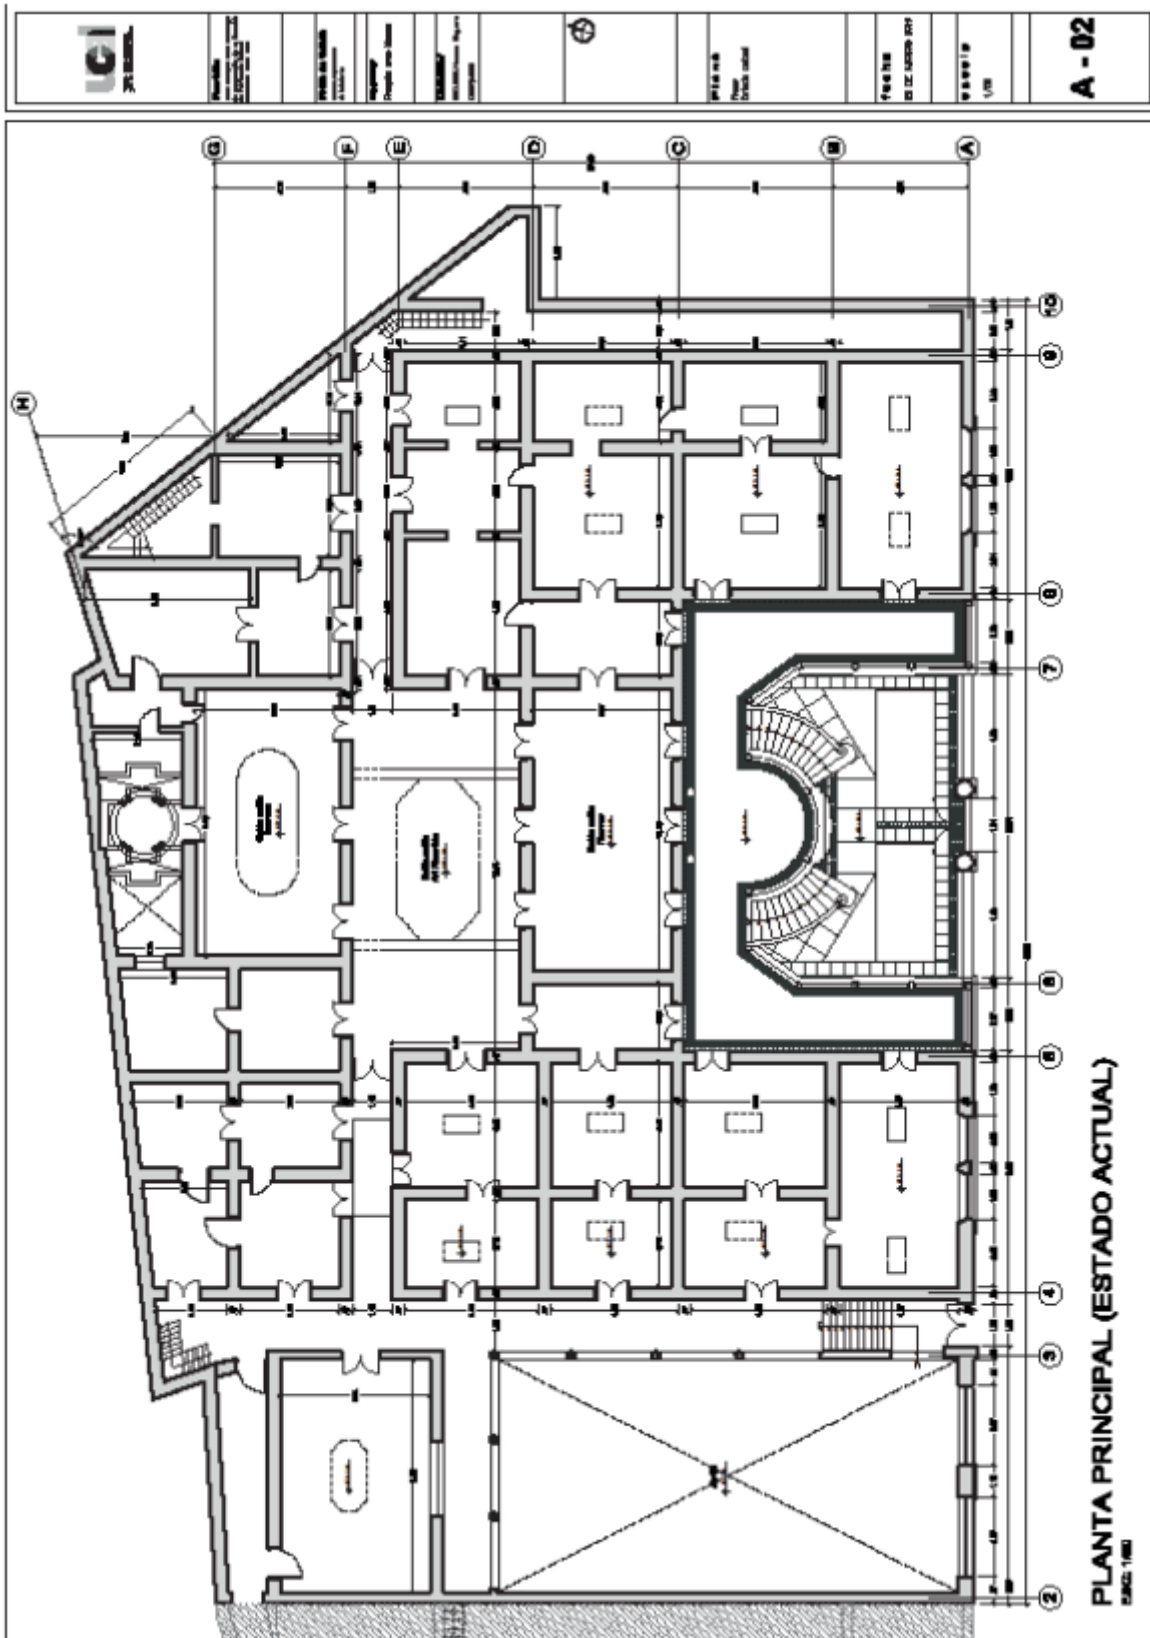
Planimetría de la planta principal de la casa Rosell Ríos
